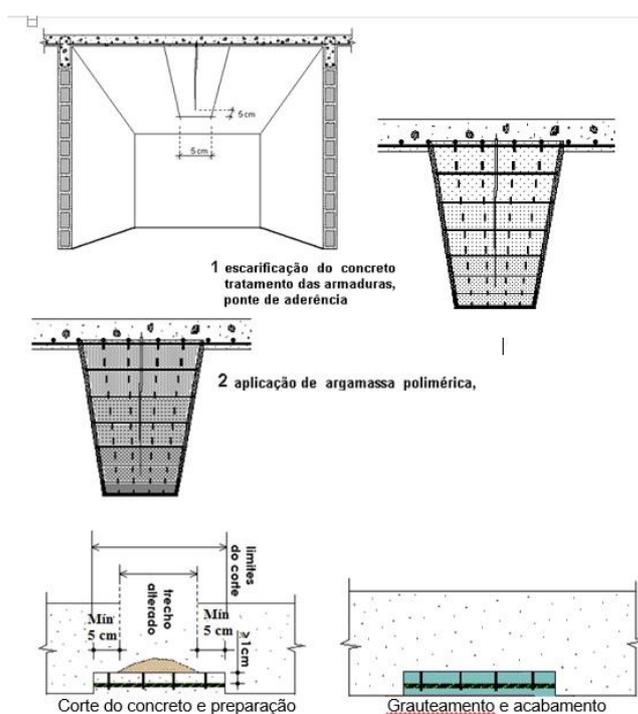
Procedimento executivos de recuperação das armaduras da laje.
